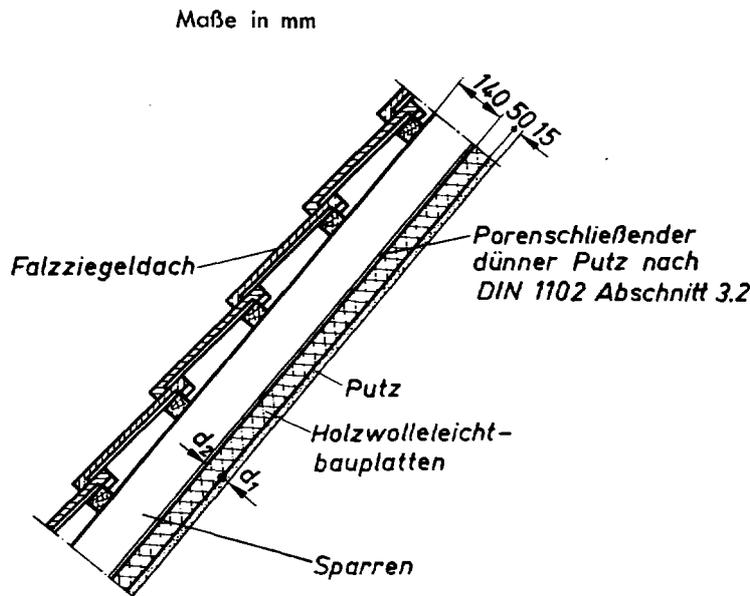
Dachschräge eines ausgebauten Dachgeschosses, mit Holzwolle-Leichtbauplatten verkleidet
